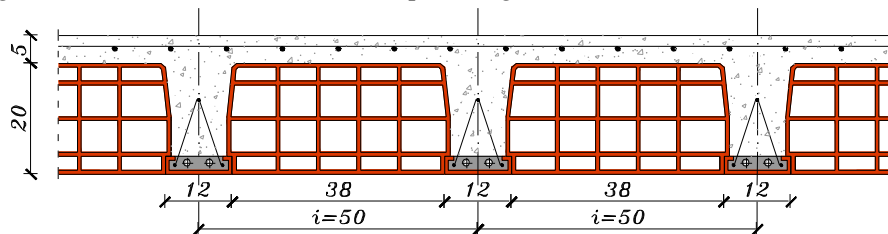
Sezione trasversale di calcolo di un solaio in latero-cemento
